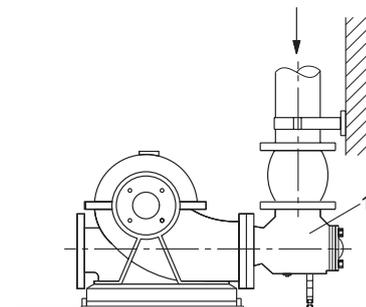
Диффузор (1) во всасывающем трубопроводе
